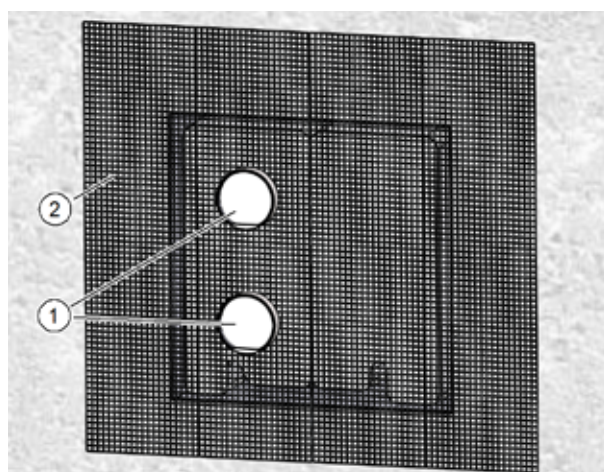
Intonacatura della cassetta a muro con elemento di riempimento
